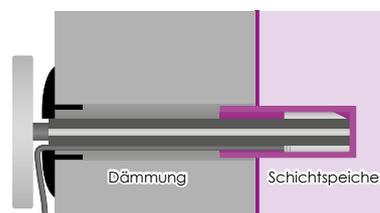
Das Steckmodul ist bis zum Anschlag in die Tauchhülse geschoben.
